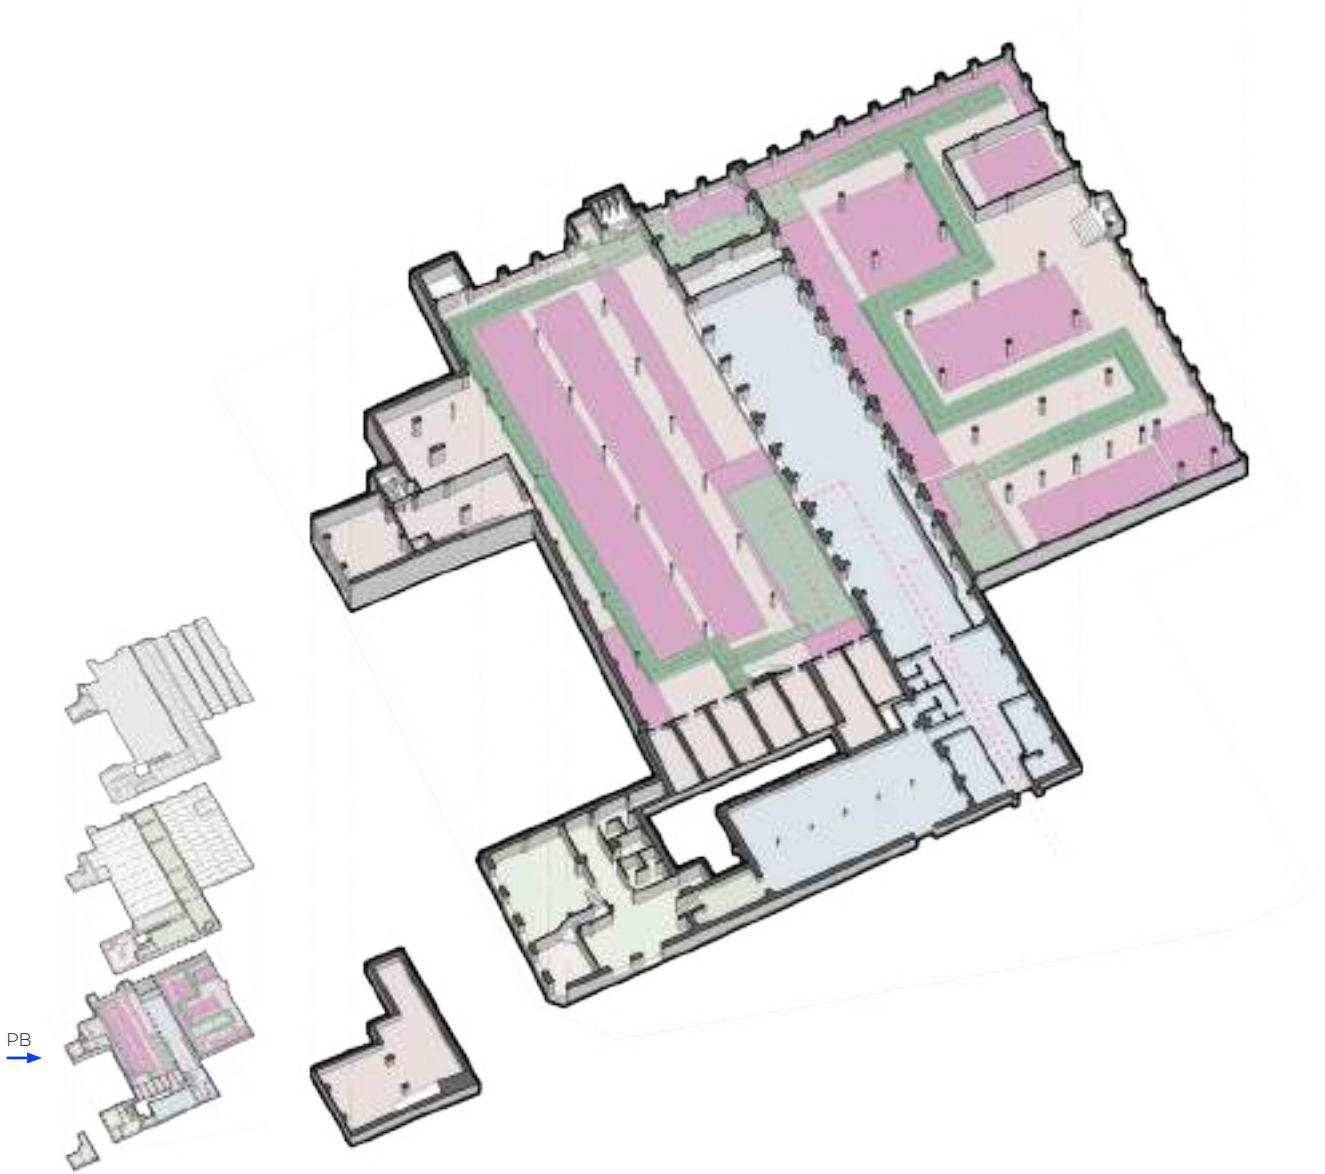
Recorrido museográfico. Axonometría de planta baja
